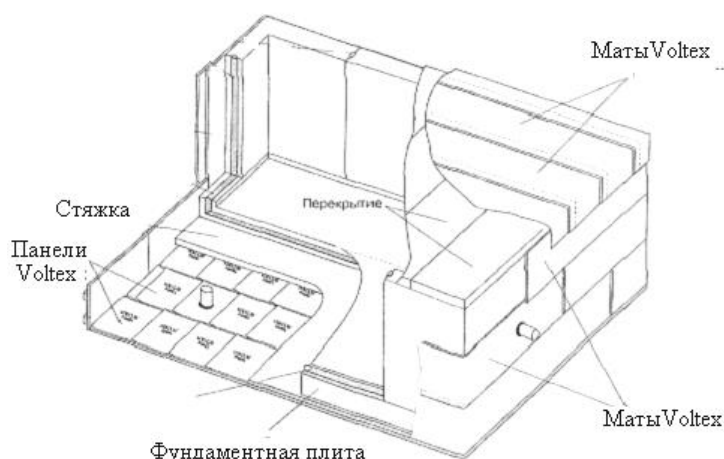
Устройство монтируемой гидроизоляции из панелей и матов на основе бентонитовой глины
